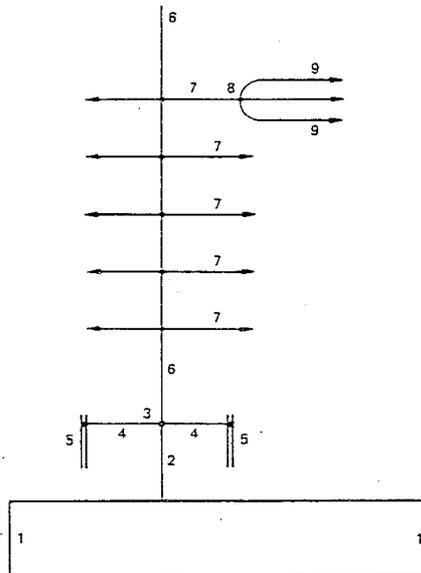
Installation de mise à la terre d'un bâtiment collectif
